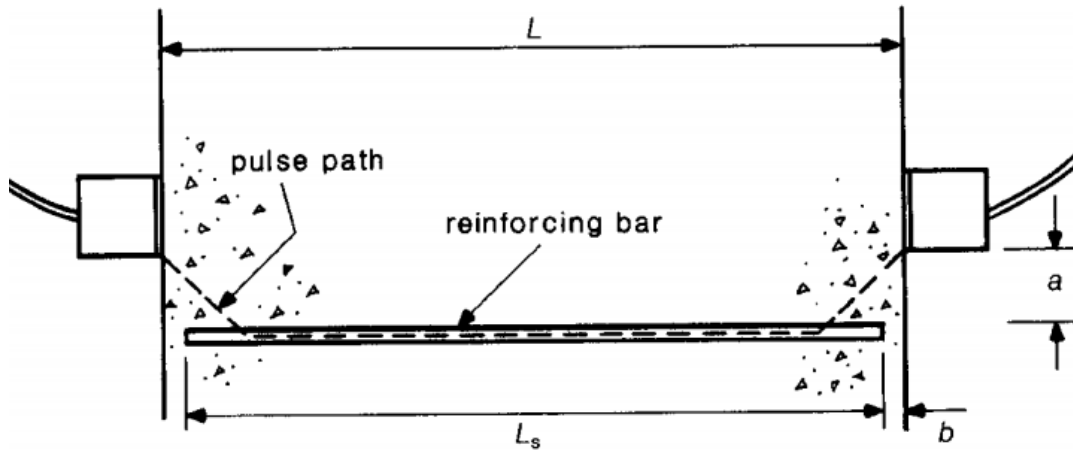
(Adaptado de J. Bungey, S. Millard y M. Grantham, Nondestructive testing of concrete structures, Taylor & Francis, New York, 2006.)
